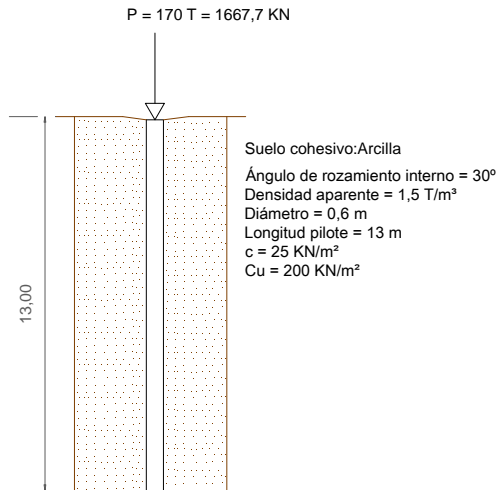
Croquis de pilote con diámetro 0,6 m y longitud pilote 13 m
